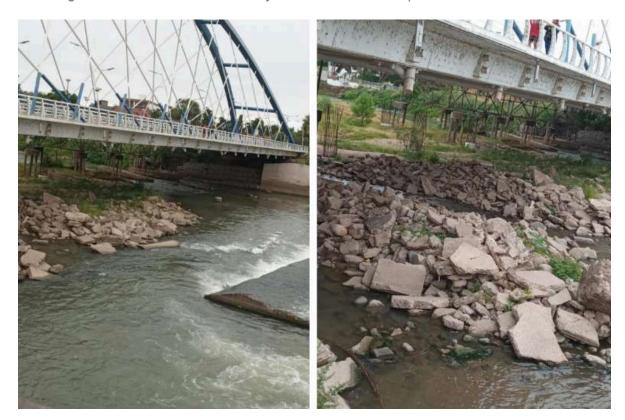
Puente Juan D. Perón y las obras de desvío para su reconstrucción.
